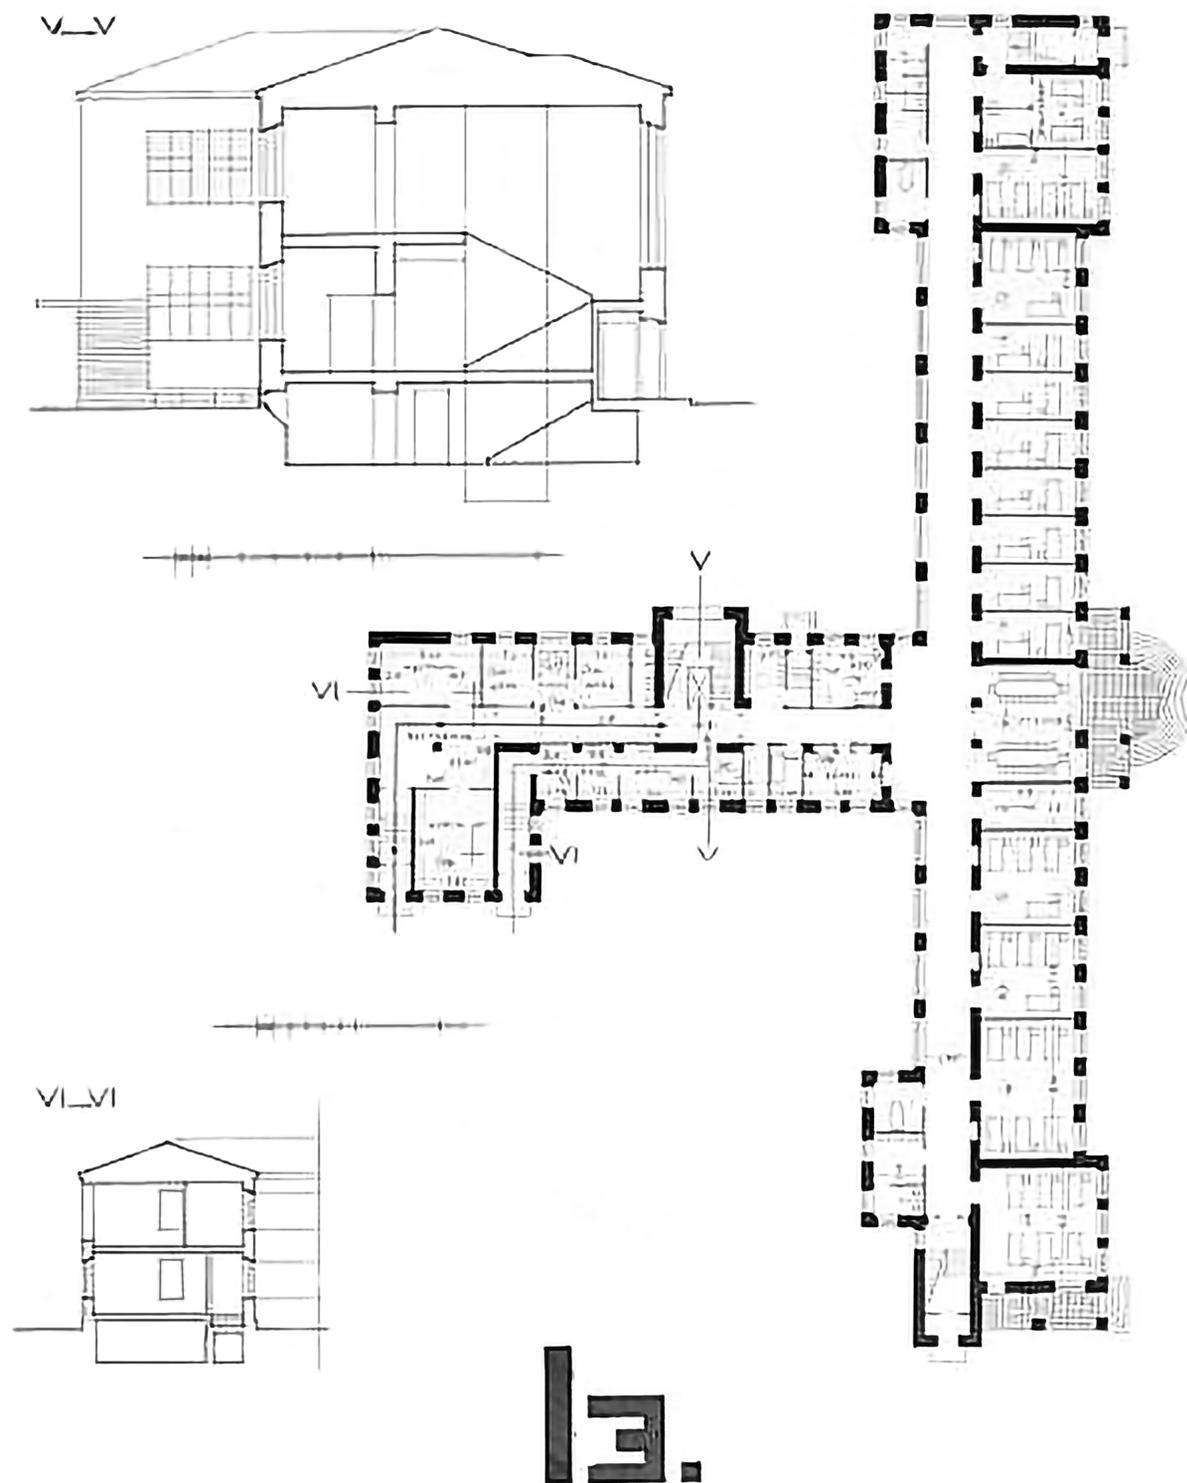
Больница им. Ф.Ф. Эрисмана. Хирургический павильон. План первого этажа, разрезы фасада [12]
